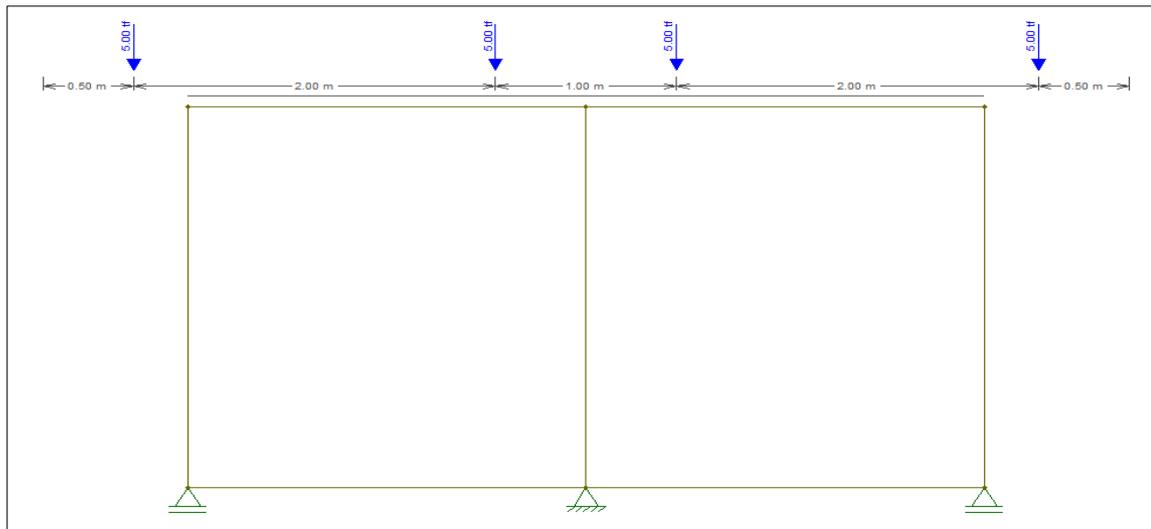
Carga móvel sobre a galeria – distribuição transversal do trem tipo.
